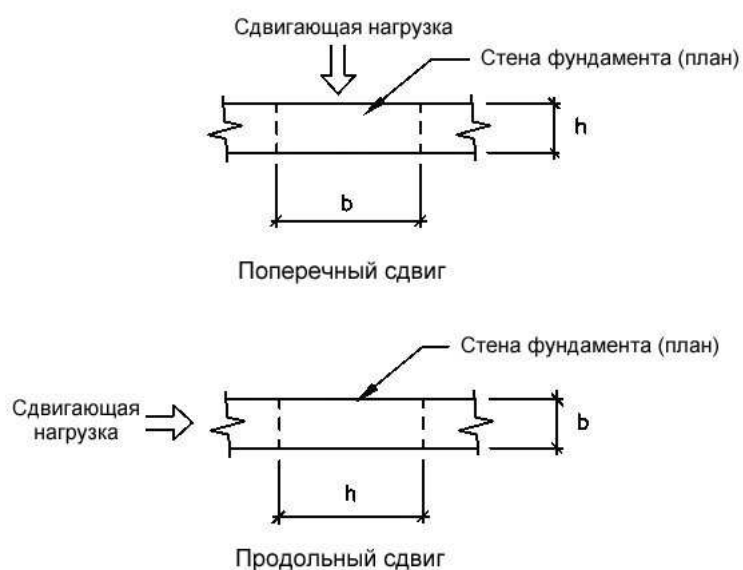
Схемы к расчету бетонных фундаментных стен на сдвиг
